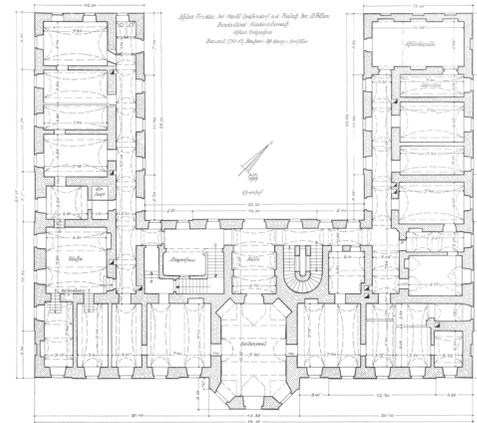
Neuschloss, Grundriss Erdgeschoss 1959.
